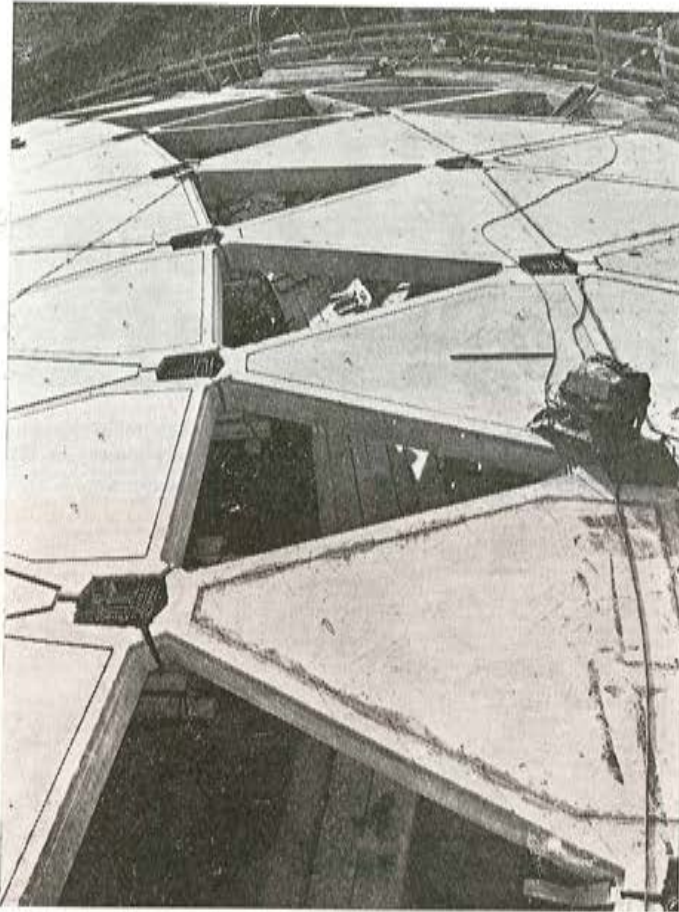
Los nudos entre los elementos de hormigón armado, prefabricados, antes de su hormigonado
